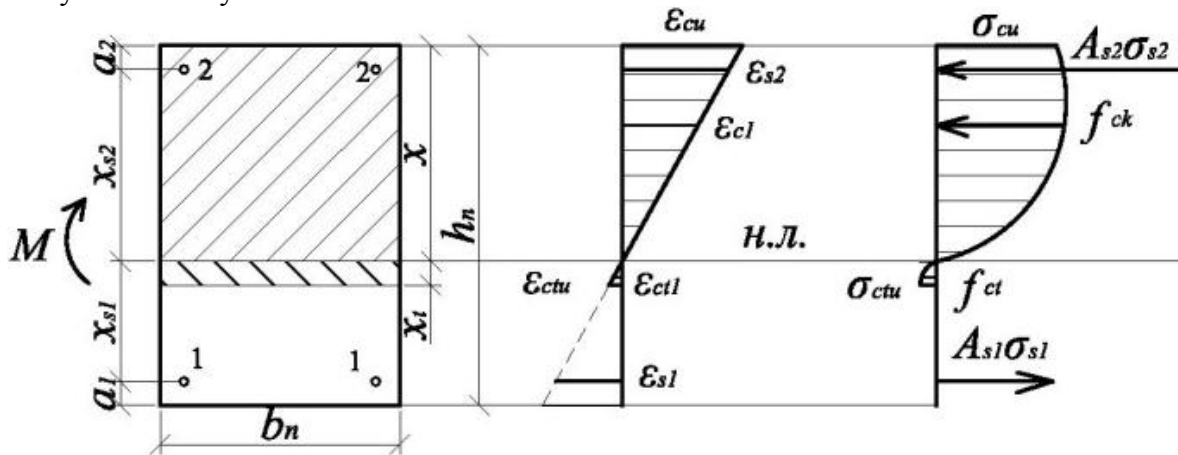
Напружено-деформований стан залізобетонного елемента, що згинається, з подвійним армуванням
